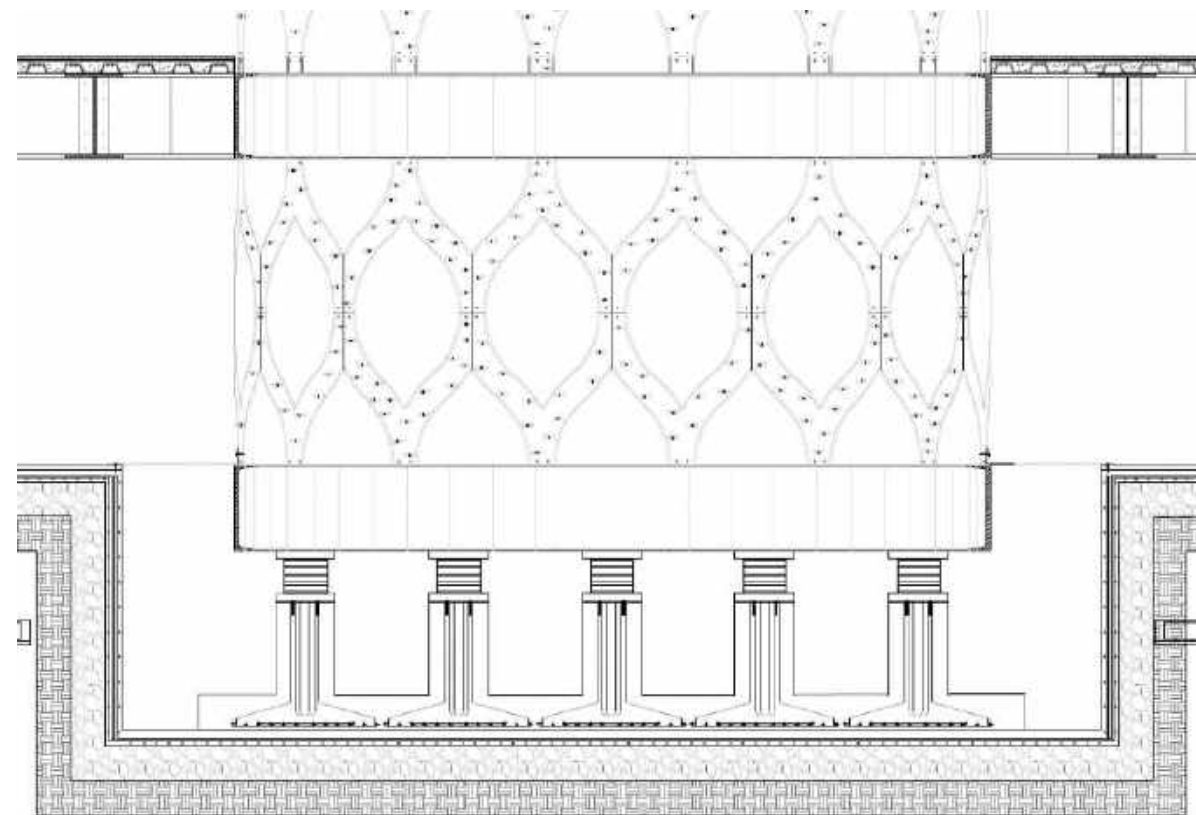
Detalle Aisladores Sísmicos en la Estructura Principal
